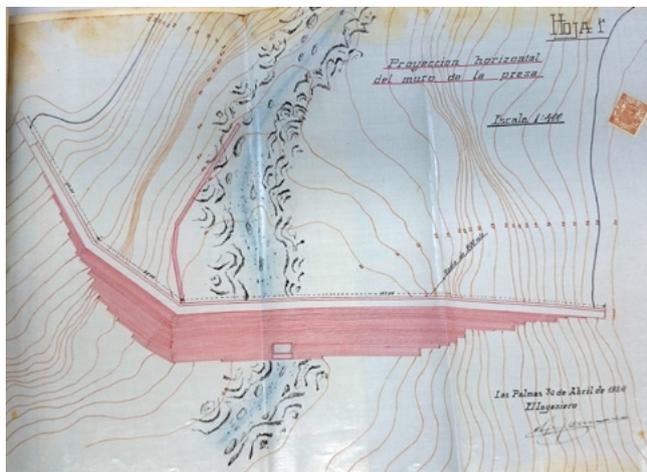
Planta del muro de Mister Leacok (1924). Fuente: Servicio Hidráulico de Las Palmas de Gran Canaria.
